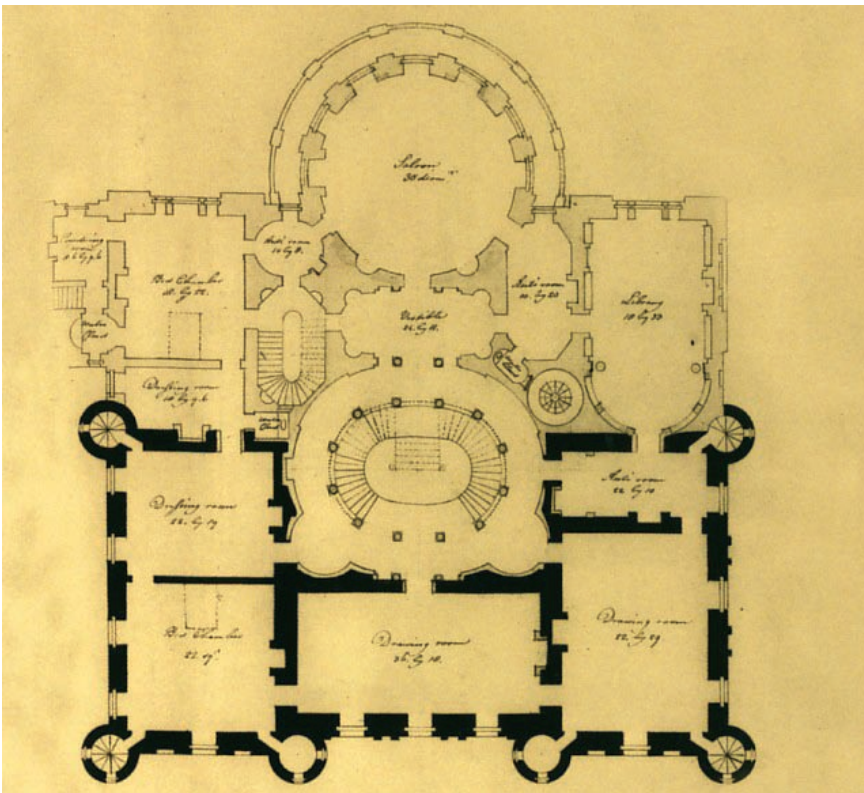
Robert Adam, Culzean Castle, Grundriss des ersten Obergeschosses, 1787 (Foto: National Trust for Scotland).
